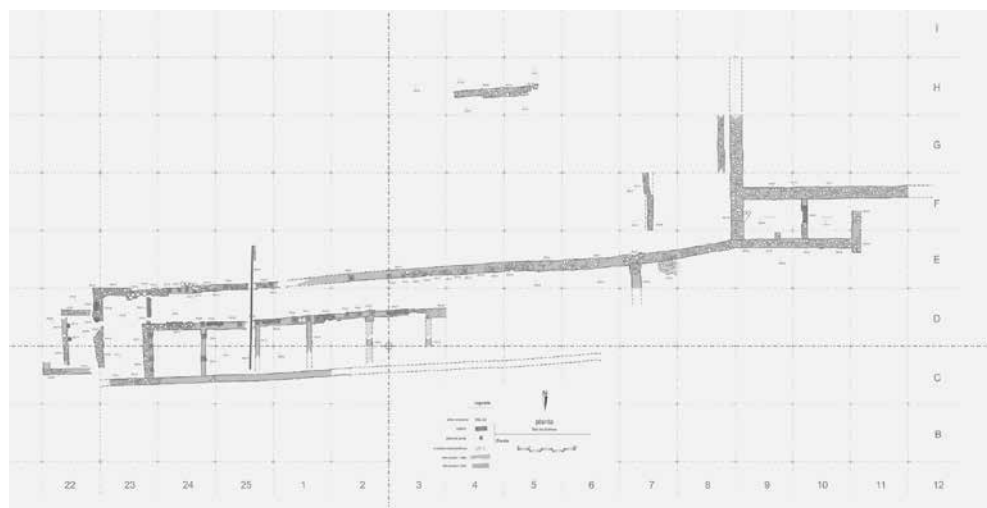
Planta do colégio jesuíta de S. Slavador (actual Mbanza Kongo)
